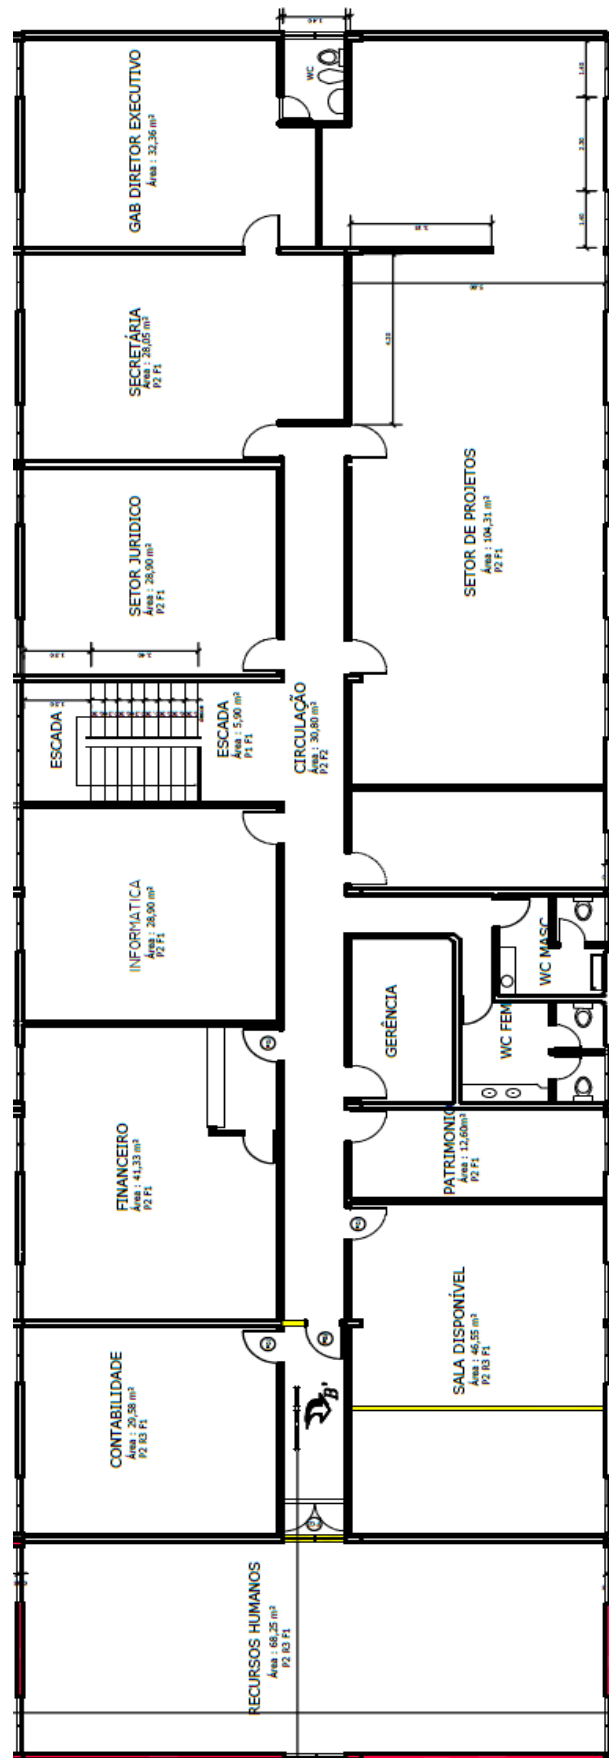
Planta baixa do pavimento superior do prédio da FADESP.
